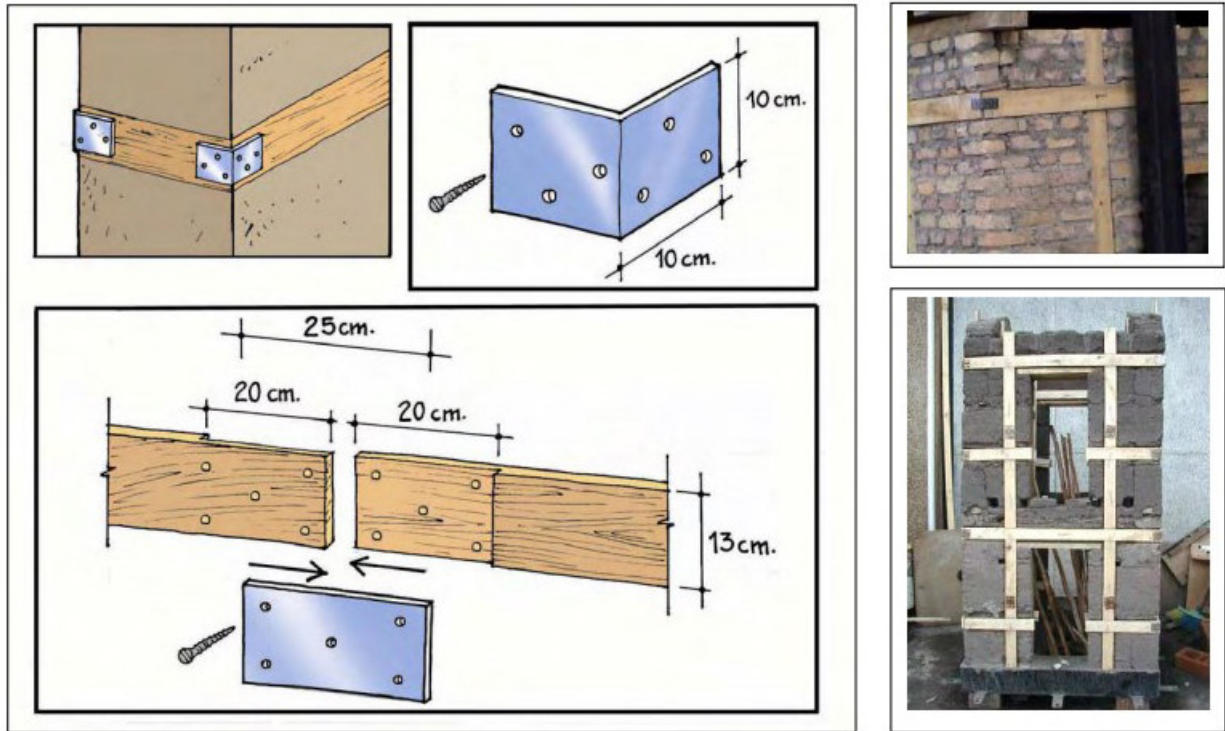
Estructura de refuerzo de la cubierta Fuente. Carlos Alberto GómezF
